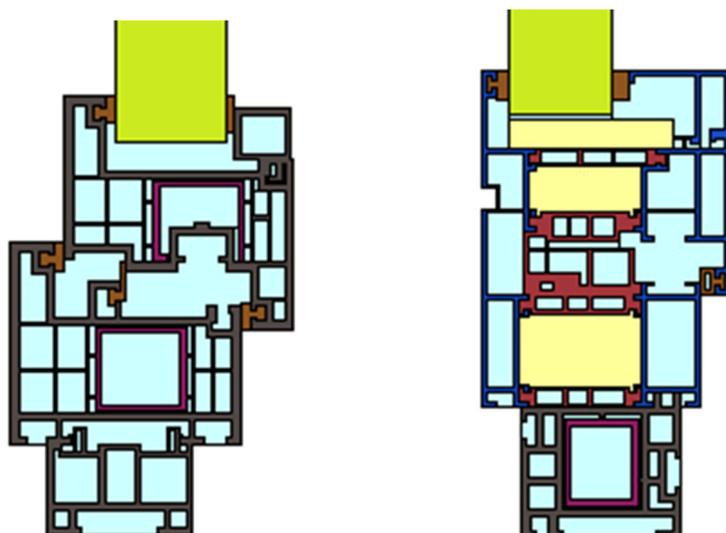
links: Referenzprofil Kunststoffrahmen mit Sohlbankanschluss; rechts: Referenzprofil Aluminiumrahmen mit Sohlbankanschluss
